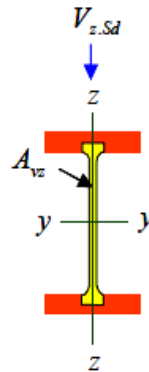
Effort tranchant dans le plan de l'âme et la section cisailée.
